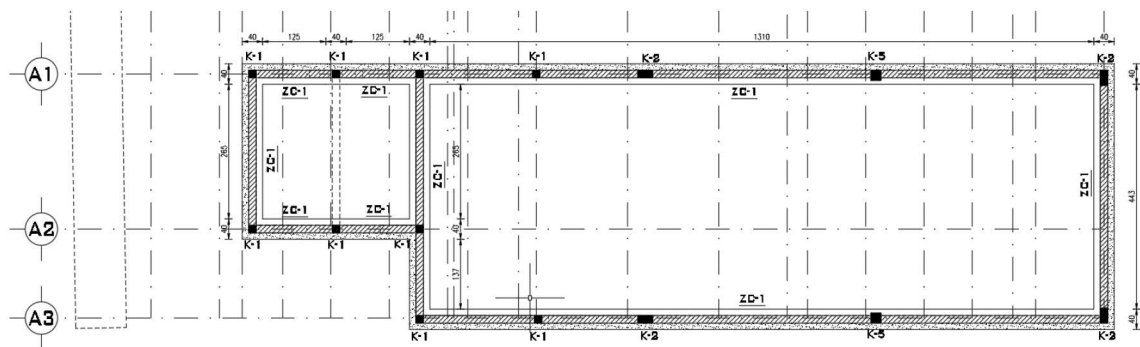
Distribución de la cimentación, el tipo de sistema constructivo tipo ZAPATA CORRIDA, de acuerdo con el comportamiento de carga, con respecto al suelo.
